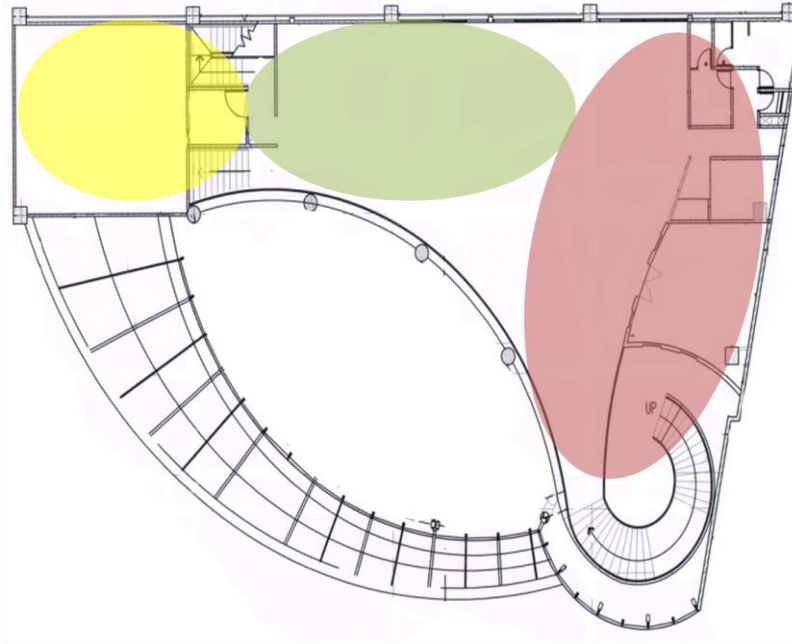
Zoning dan Grouping Alternatif 1 Lantai 2
